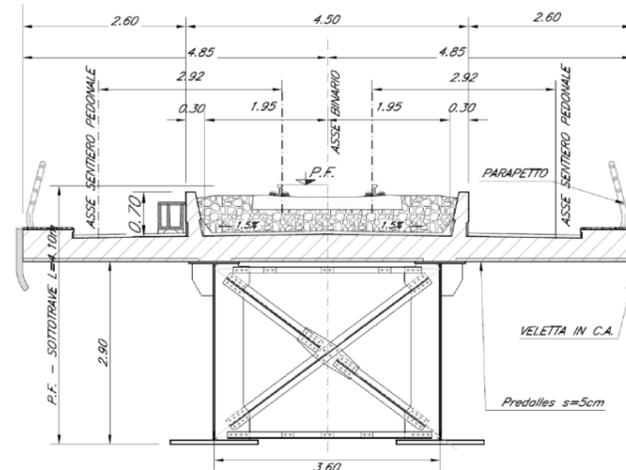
Sezione trasversale campate in acciaio-clt L=40 m - Singolo binario
